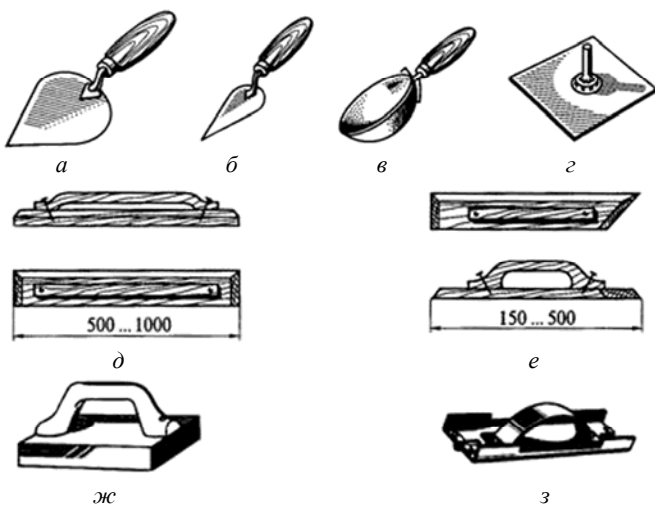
Ручные инструменты для нанесения штукатурного раствора: а – штукатурная кельма; б – отрезовка; в – ковш для отделочных работ; г – сокол; д – полутерок; е – полутерок малый; ж – терка; з – рустовка
